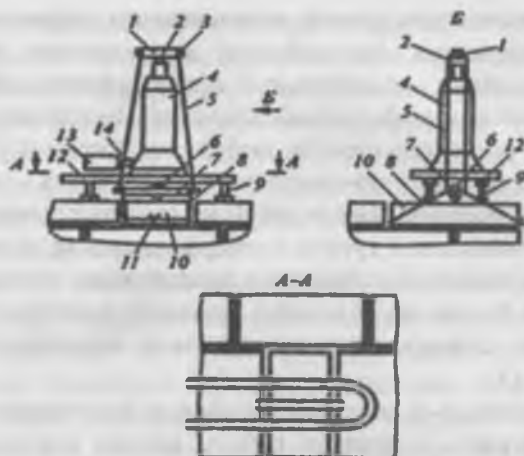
Схема испытания каменной кладки на сцепление:
